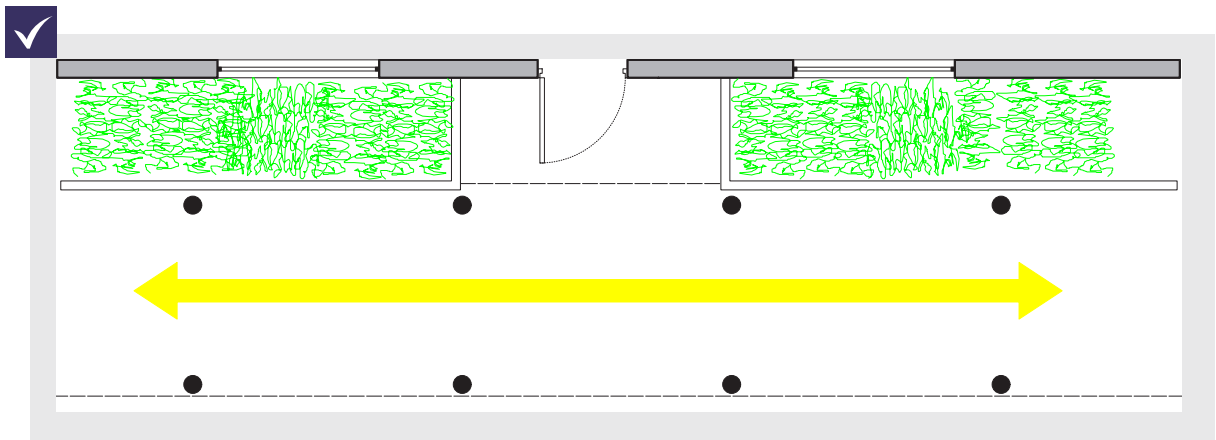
Corredor con estructura independiente de fachadas de edificios permite salida sin interrumpir flujo de circulación.
